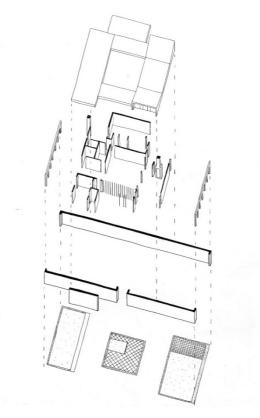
Dibujo a tinta realizado por Darío Lavado Álvarez. Fuente: Archivo personal de Salvador Prieto Castro (2023)
